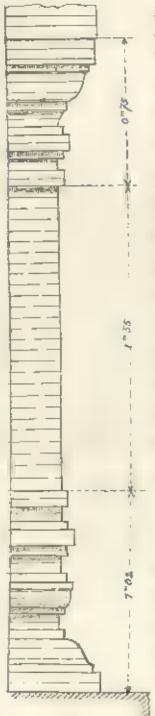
Kuţīgvara. Sanctuairo central. Profil do mur sud sur le pilastre.
